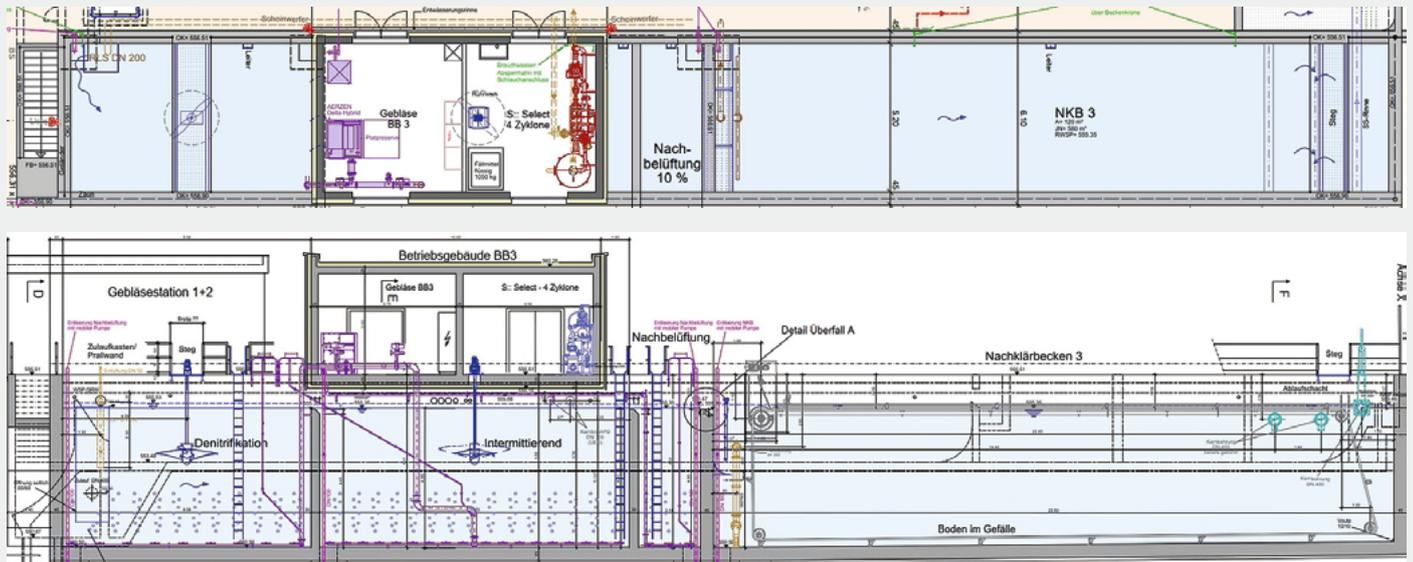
Grundriss und Längsschnitt der Biologiestrasse 3.
